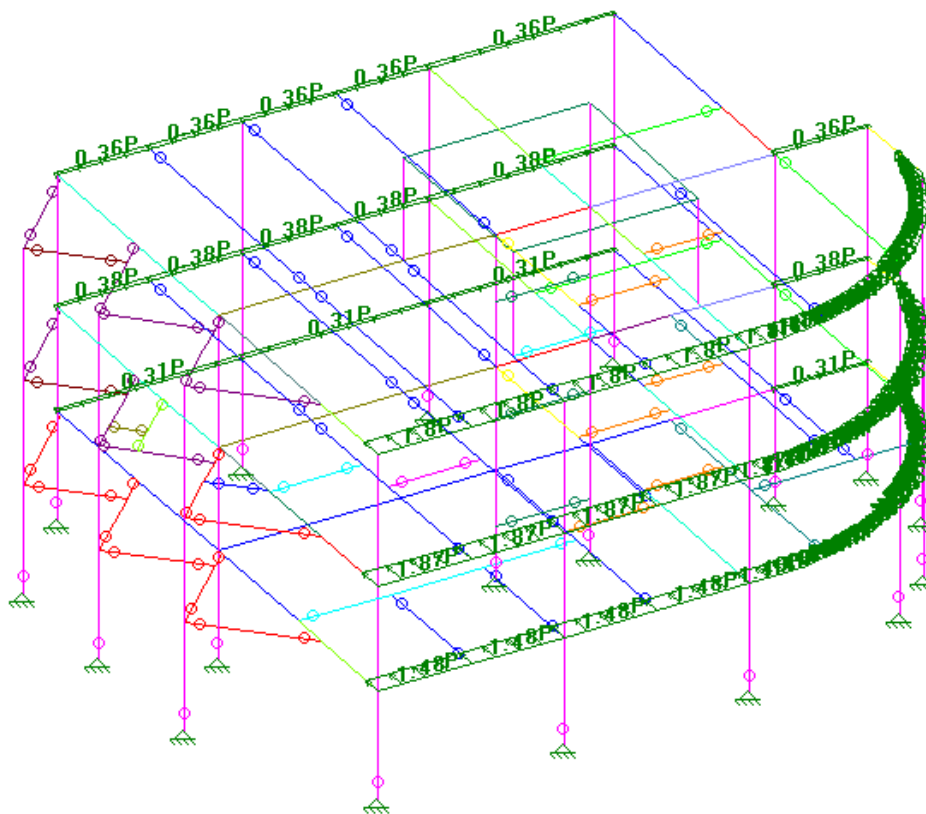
Ação do vento sobre a estrutura – Direção Y – Carregamento aplicado
